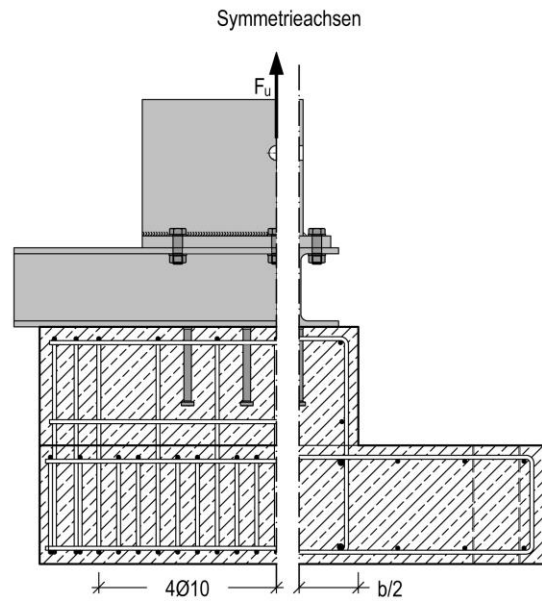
Schematischer Bewehrungsplan des Versuchskörpers R-05
